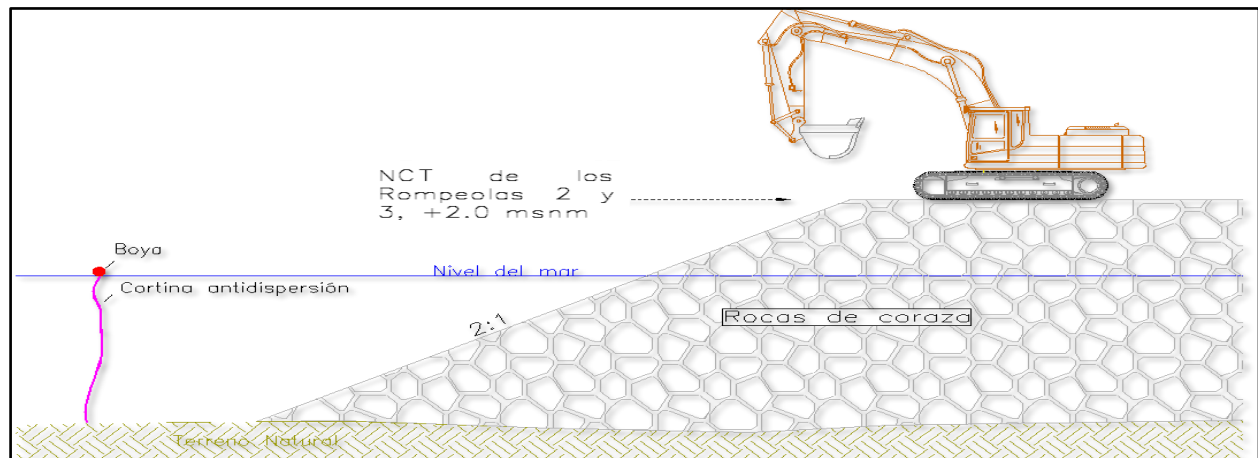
Esquema de la construcción de los rompeolas y la posición de las cortinas antidispersión.
